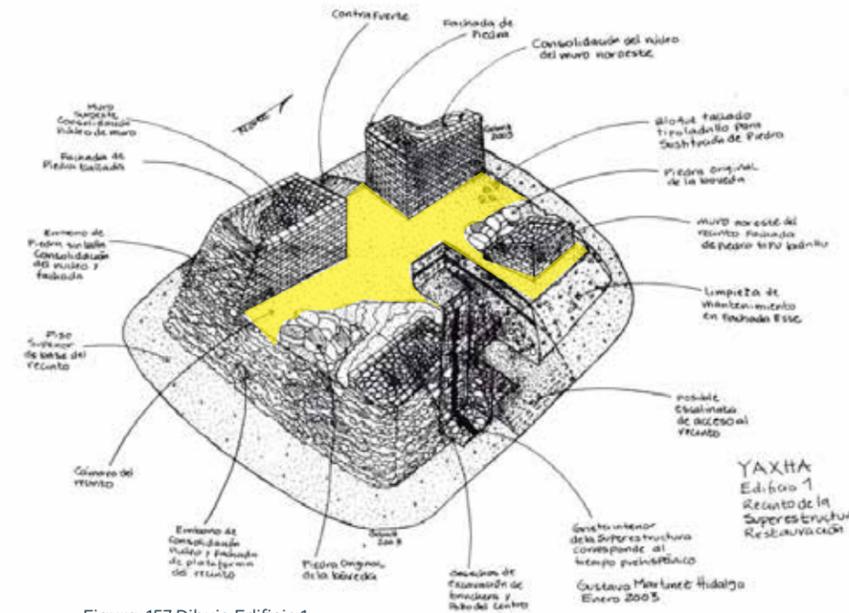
Dibujo Edificio 1 Cámara superior, reconstrucción del proceso de restauración. Pozo de sondeo, con grieta prehispánica en la parte superior del edificio. Detalle de reconstrucción en los muros de cámara. Dibujo: GAMH 2002
